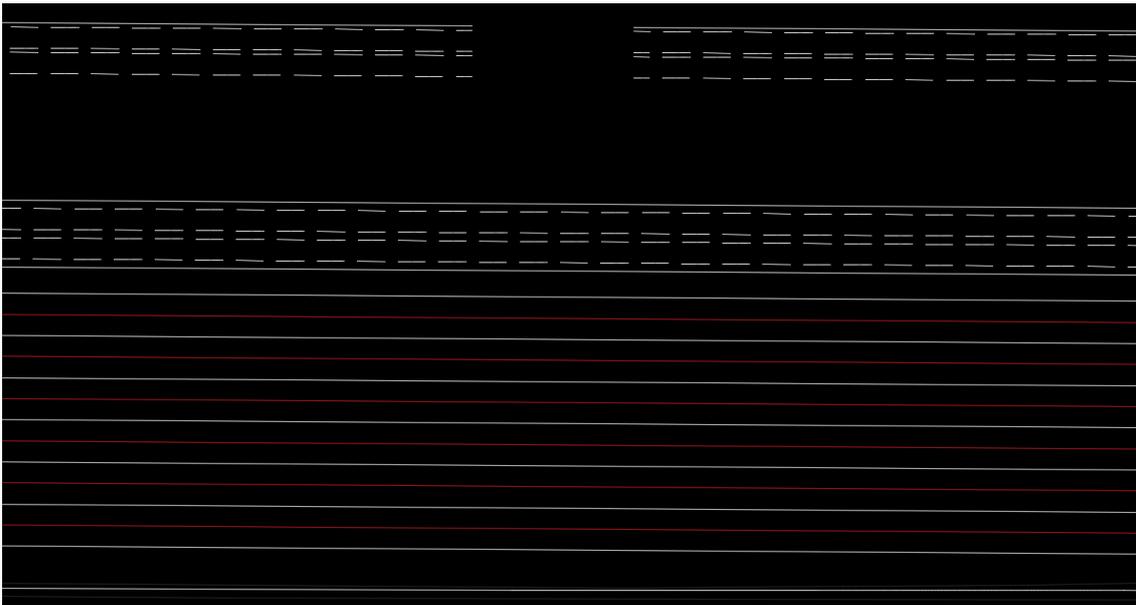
Detalle del Diseño en Planta de la Terminal Ferroviaria. Elaboración Propia
